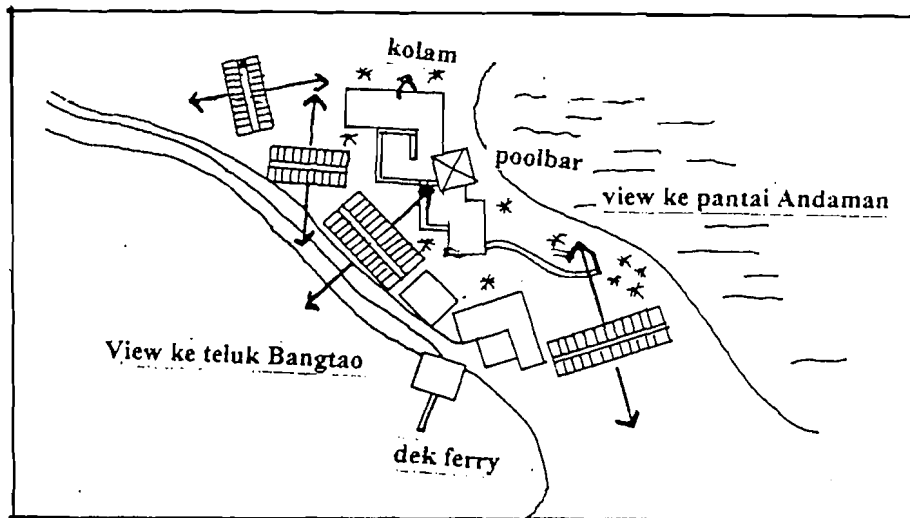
Site plan Laguna beach club, Phuket, Thailand
